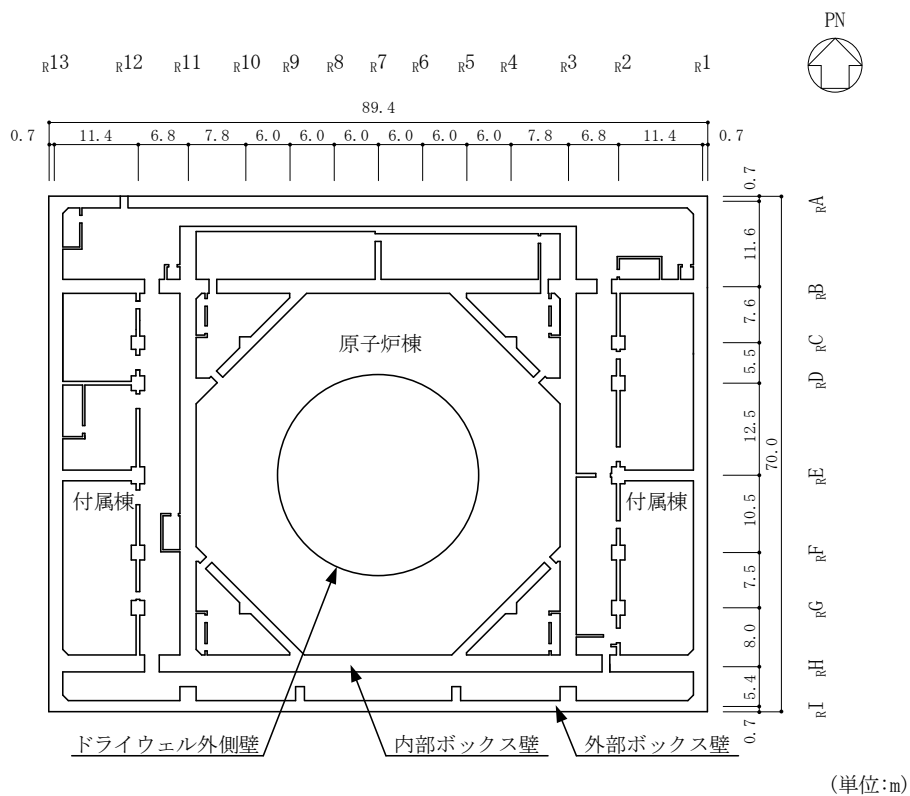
原子炉建物基礎スラブの概略平面図 (EL 1.3m*)
